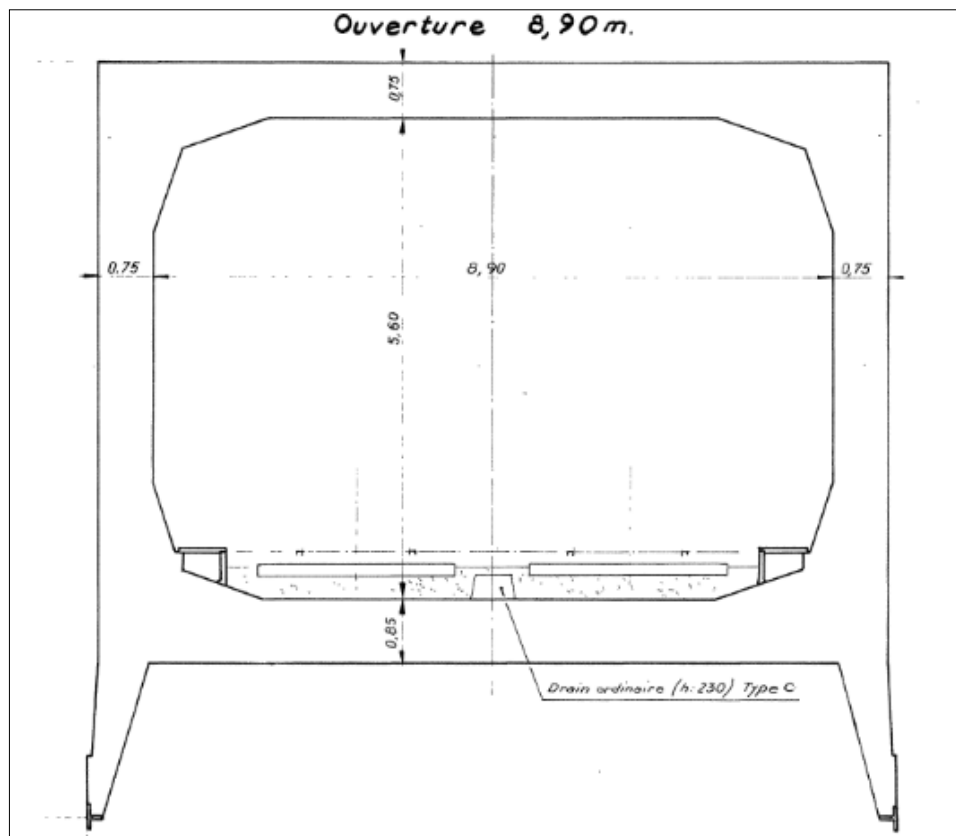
Coupe schématique d'ouvrage de type caisson foncé
